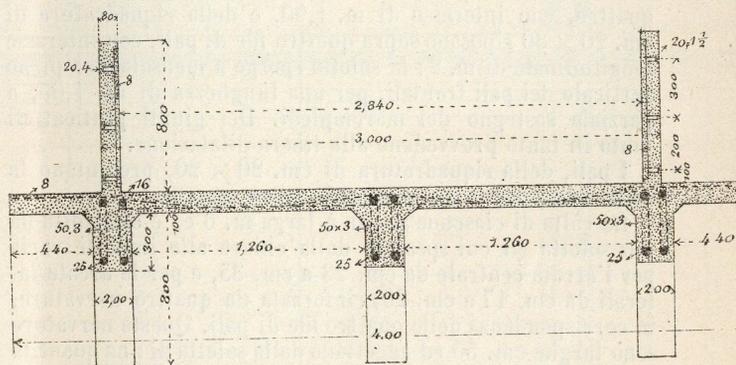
Sezione trasversale del Ponte-Canale presso Evilard (1897).
